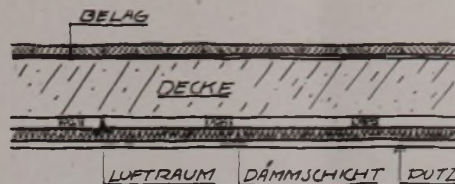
Massivdecke in gleicher Ausführung und Wirkung, jedoch mit zusätzlich dämmendem Luftraum. Die Befestigung der Leisten ist auf Dübel zu bewirken, die im Beton mit eingestampft werden. Das Dämmvermögen der Decke kann an der Untersicht durch dichten Putz in verlängertem Zementmörtel erhöht werden, der hierbei dem Kalkputz überlegen ist.
